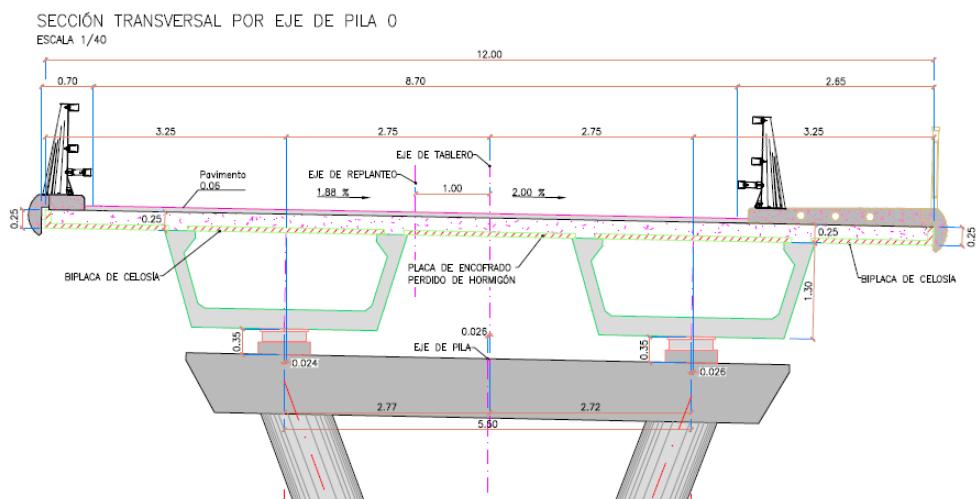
Tablero de vigas prefabricadas hiperestáticas.
